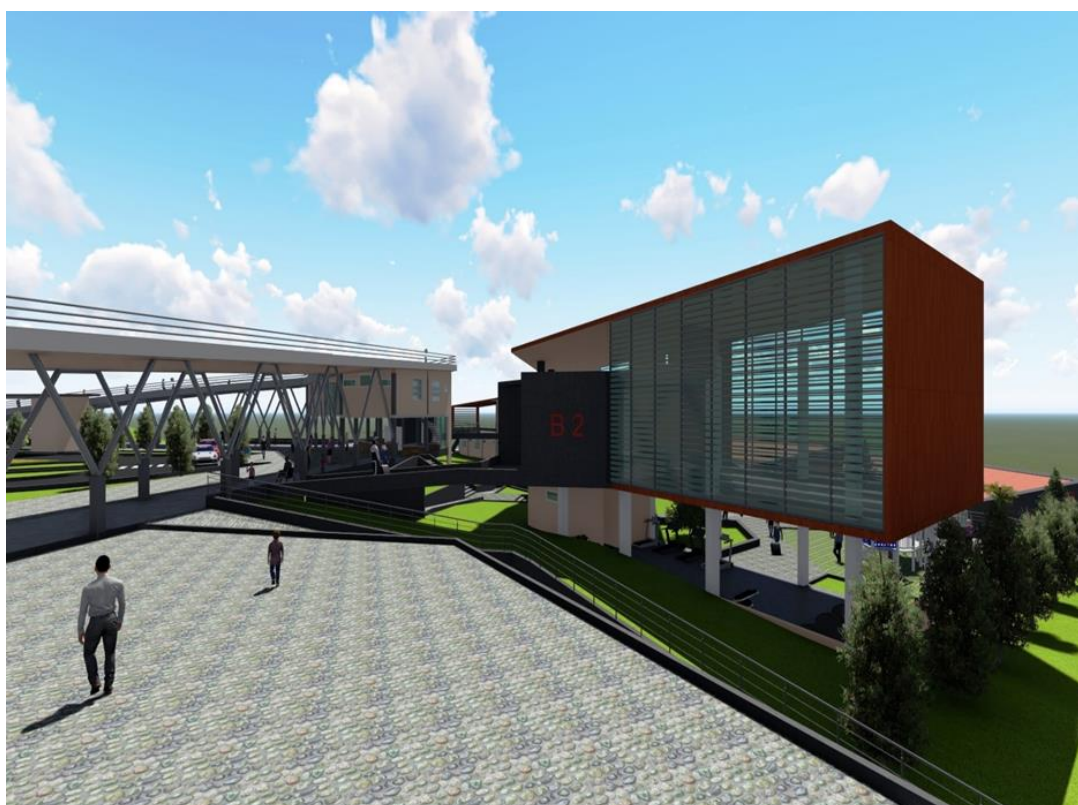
Vista 02, Galerías de exposición. Fuente: Elaboración propia
